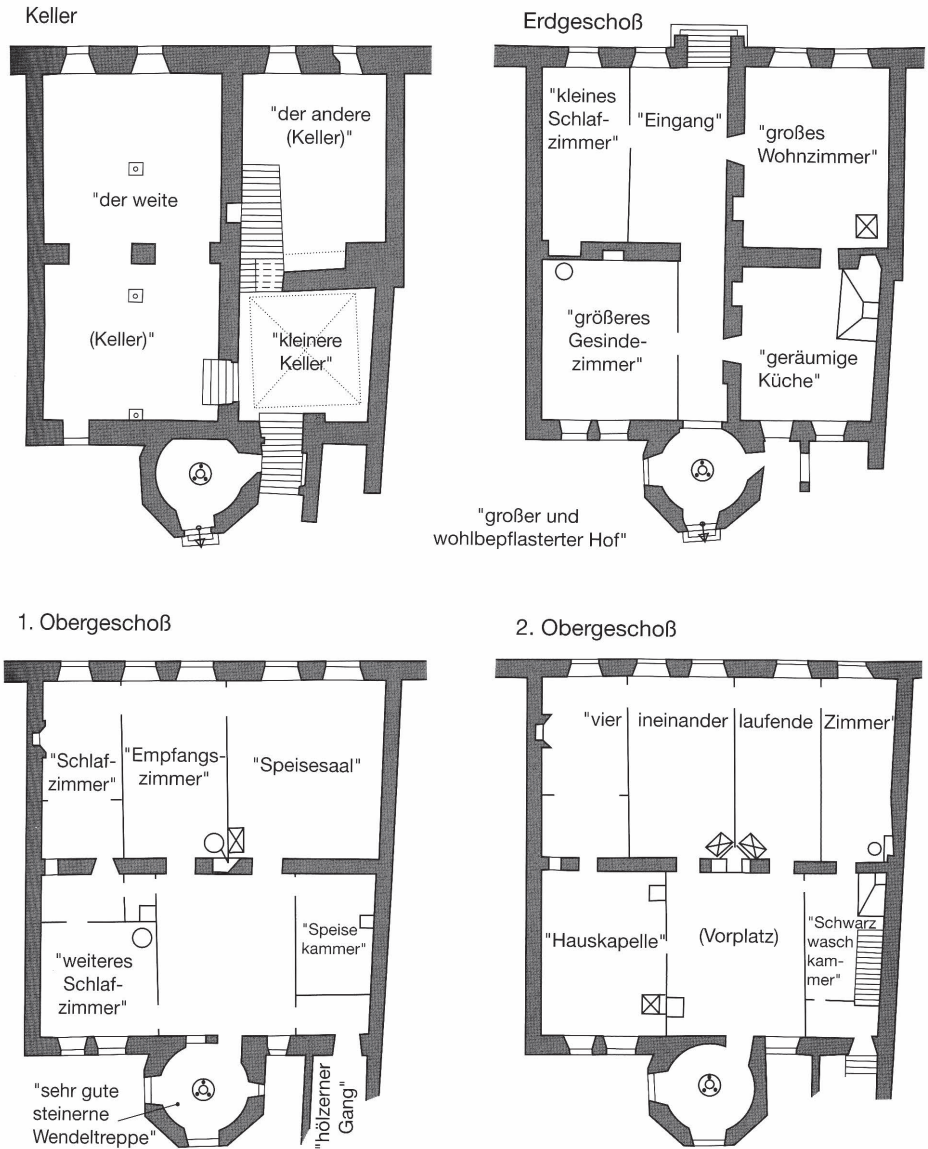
Stadthof des Klosters St. Blasien in Freiburg, Salzstr. 18, Grundrisse nach dem Inventar v. 1806
